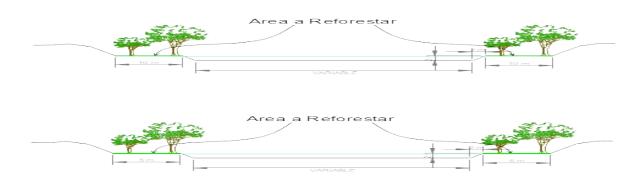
Sección tipo del cauce con el proyecto finalizado.
